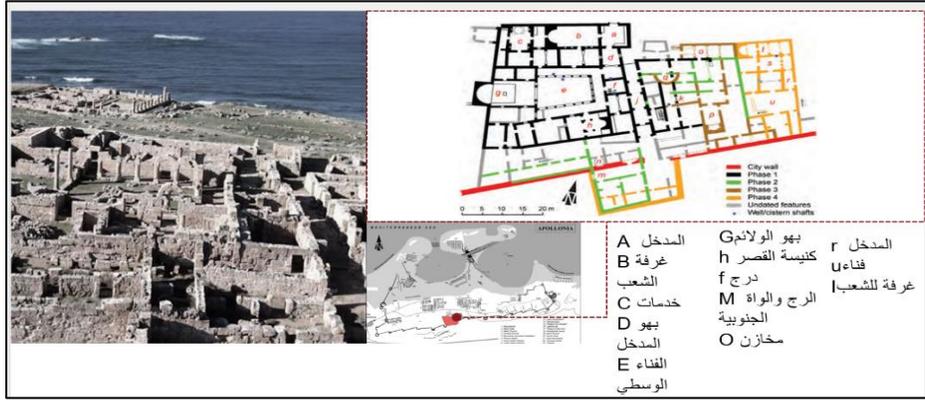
مراحل مخطط الكنيسة الغربية، المصدر: (Kieran Westley, 2023) بتصريف من الباحث
